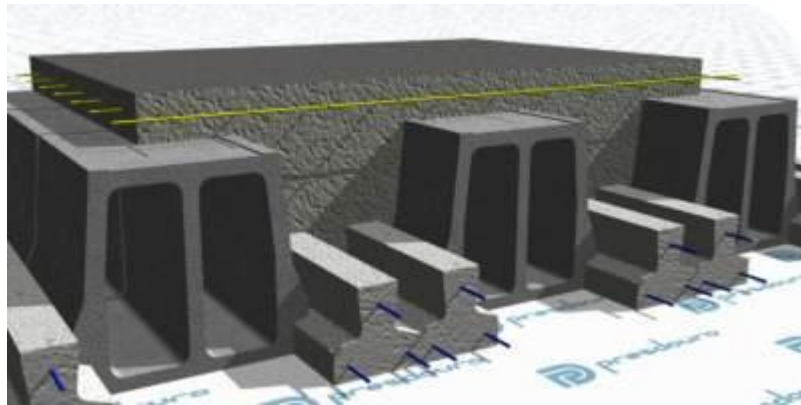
Modelo tipo de laje de vigotas pré-esforçadas [10]
